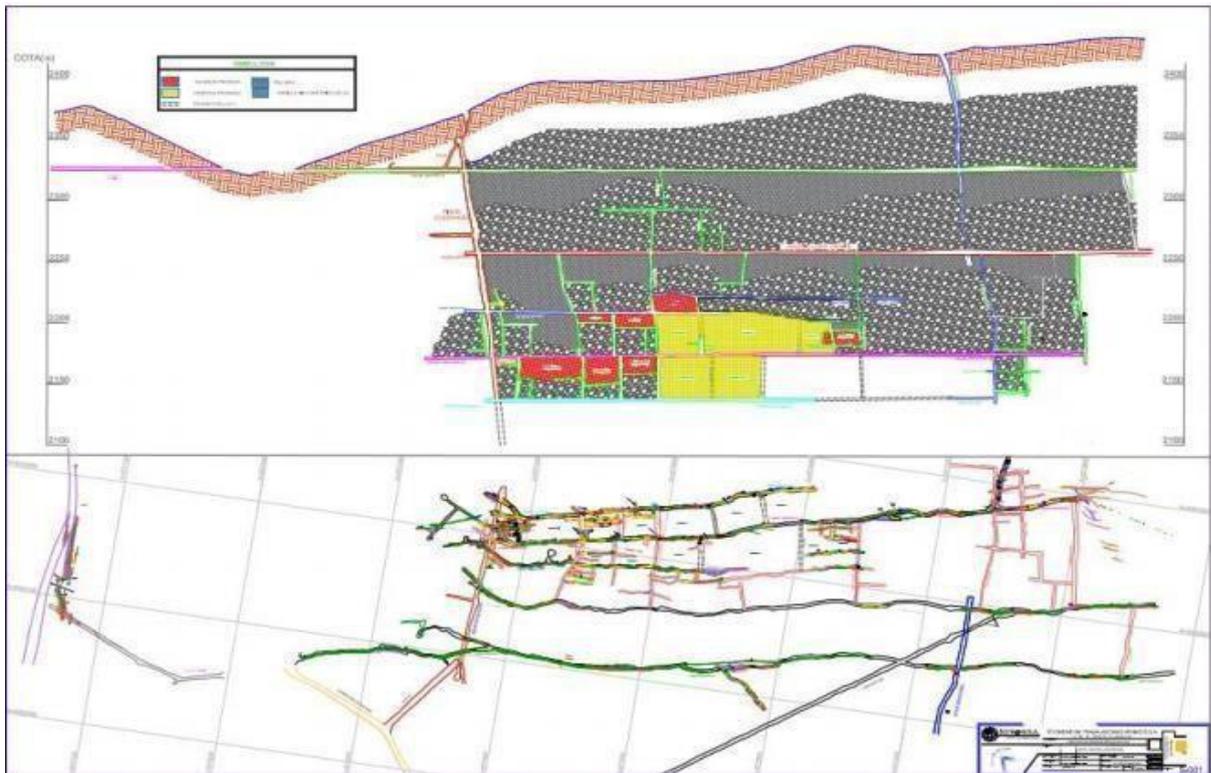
Vista planta de las labores de la Mina Filomena 100
